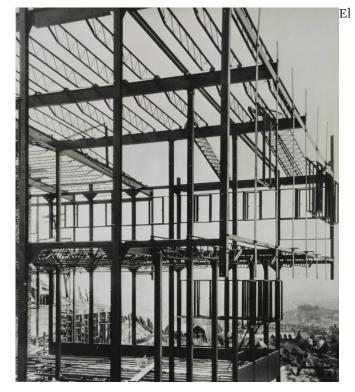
Vista desde el Noroeste de la estructura, con forjados y fachadas desnudas, de la Lovell Health House durante su montaie.
